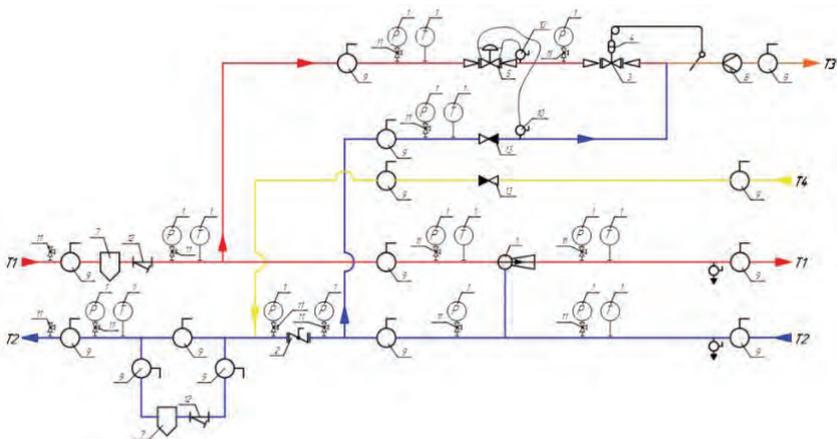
Схема теплоснабжения абонента до реконструкции
